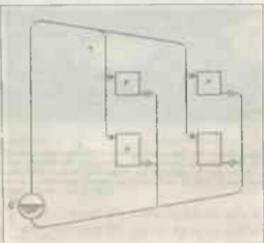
Schéma d'une installation de chauffage central à vapeur.
